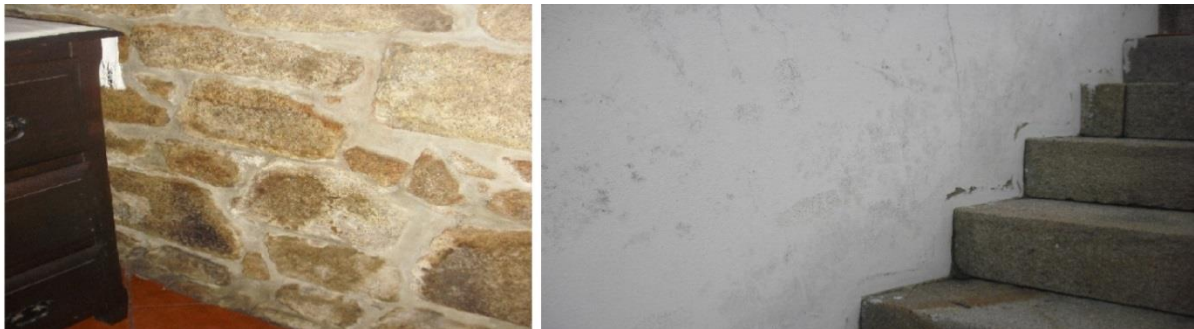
Vista interior e exterior da fachada exterior do hall de entrada
